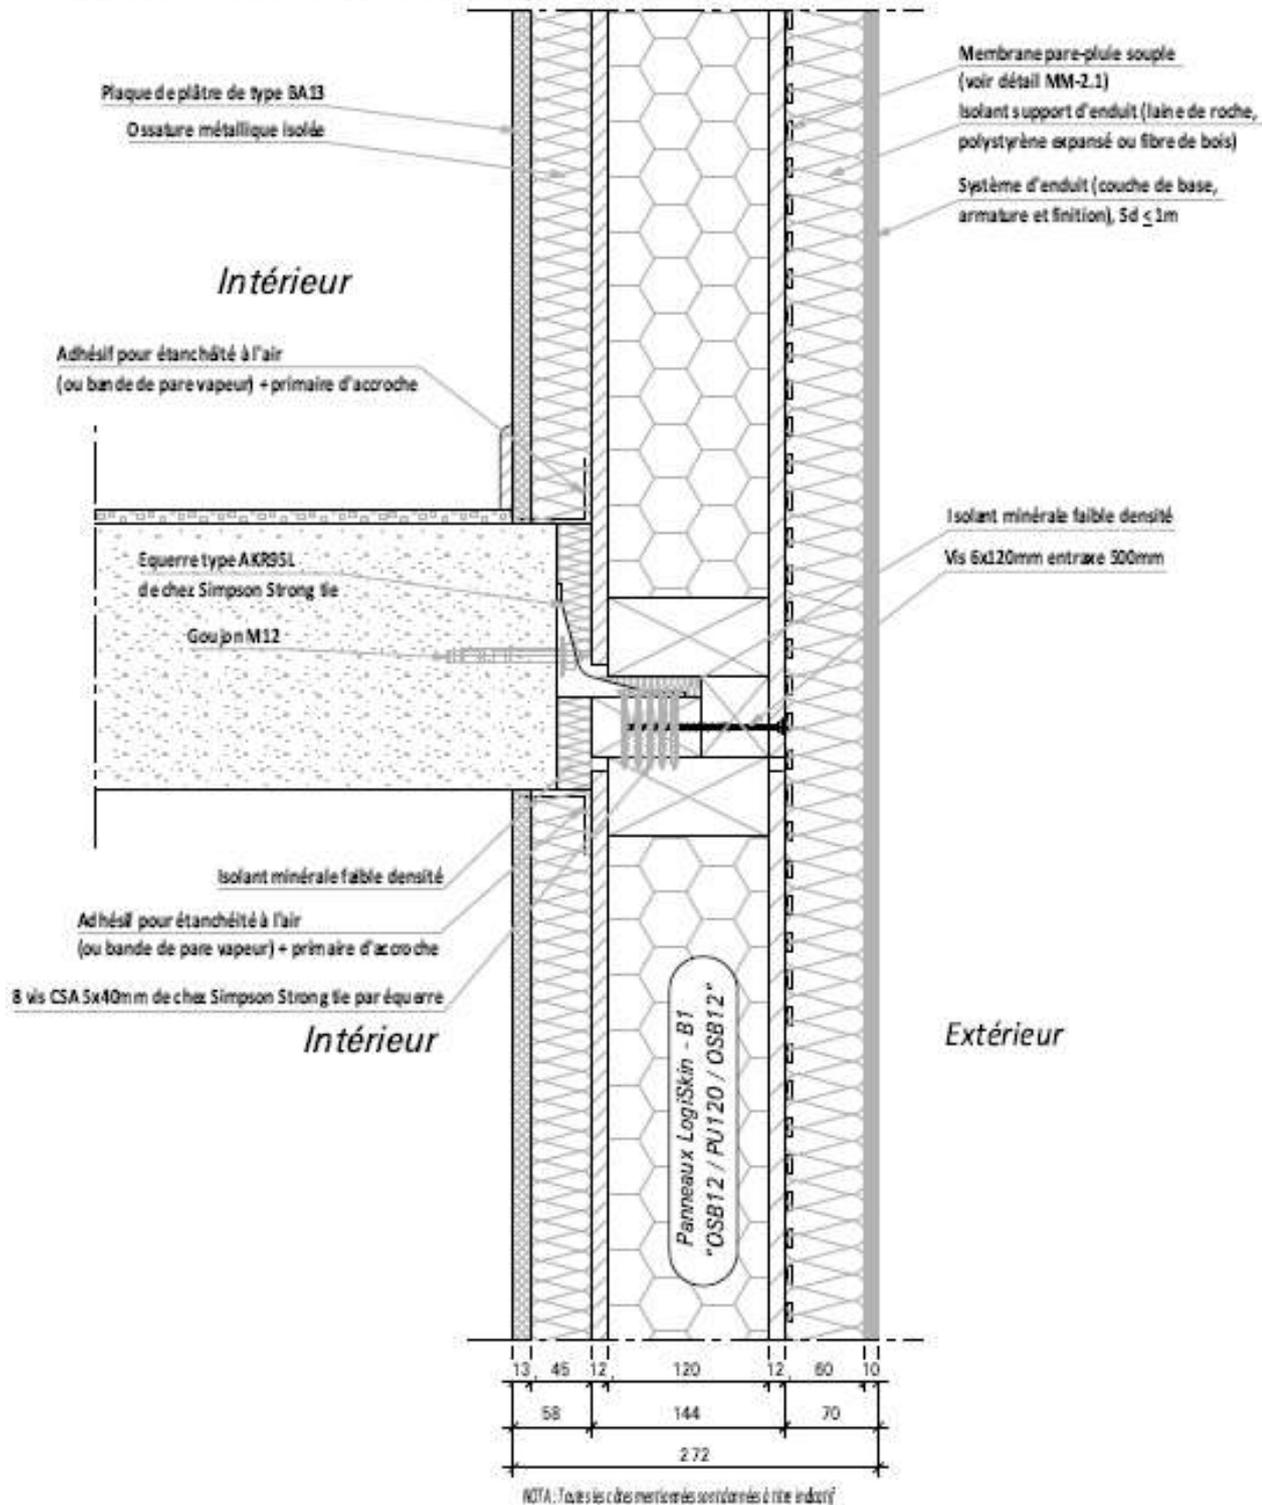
Détail CV-2.1 – jonction avec plancher (mode de pose 1)
